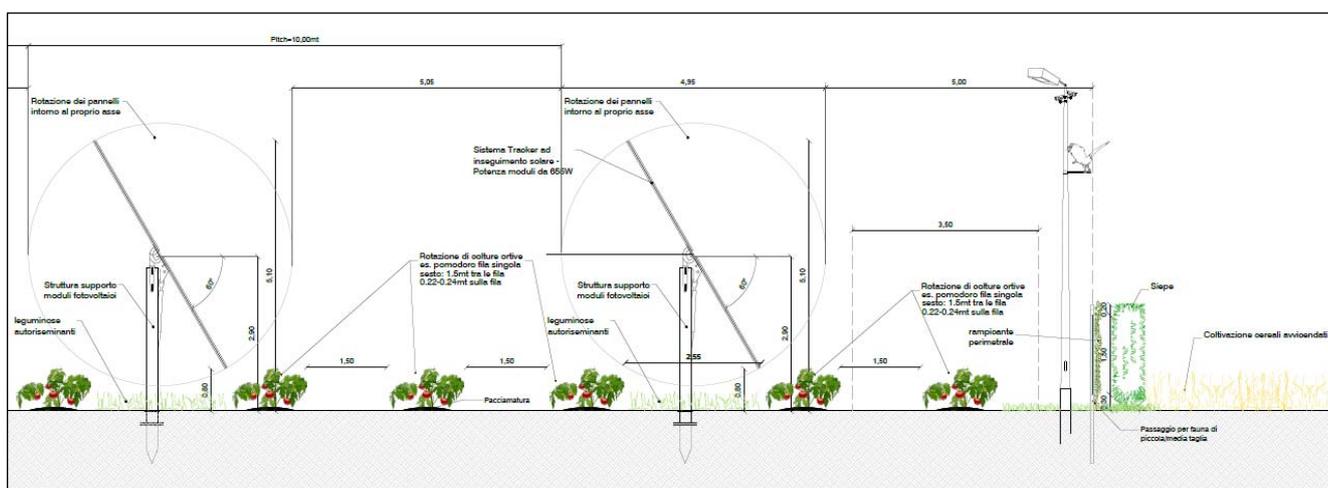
Sezione tipo con rotazione ortive (es. pomodoro) tra le fila delle strutture
